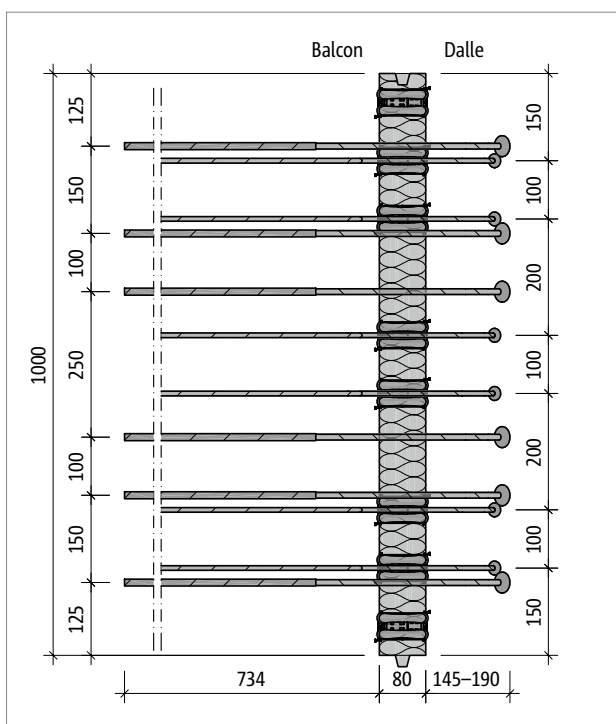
Schöck Isokorb® T type K-O-M2 : plan de base du produit
